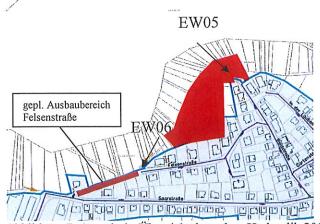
Ausschnitt Übersichtslageplan; Hydraulik 2012 mit Ergänzung NBG und Ausbaubereich Felsenstraße
